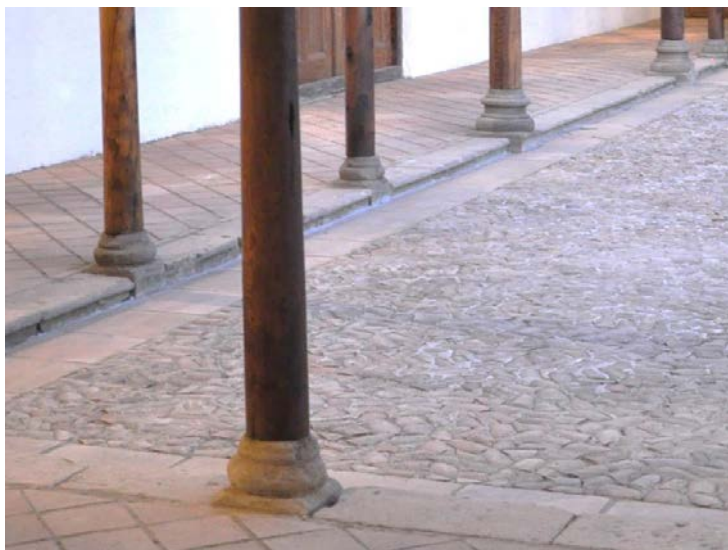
Baza de piedra y pilar de sección redonda (fotografía de la autora; olivar 2014)
